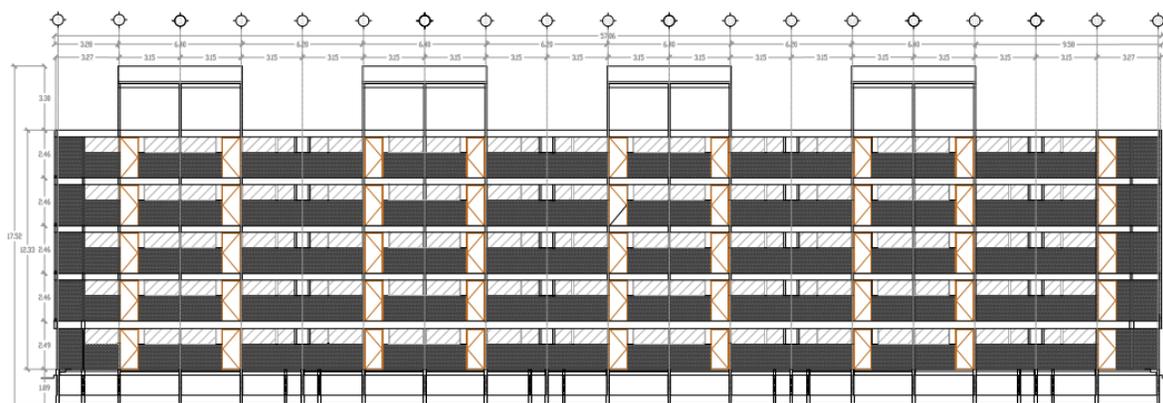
Planta arquitectónica del edificio 3B www.obras.cdmx.gob.mx
